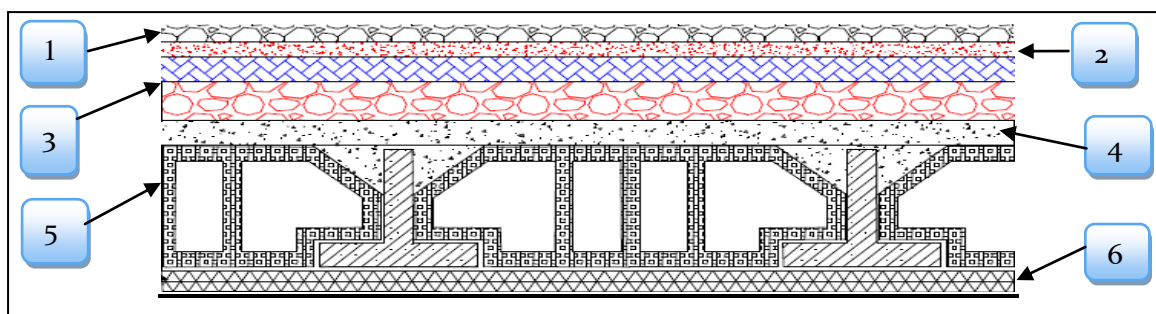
Schéma d'un plancher de terrasse inaccessible
